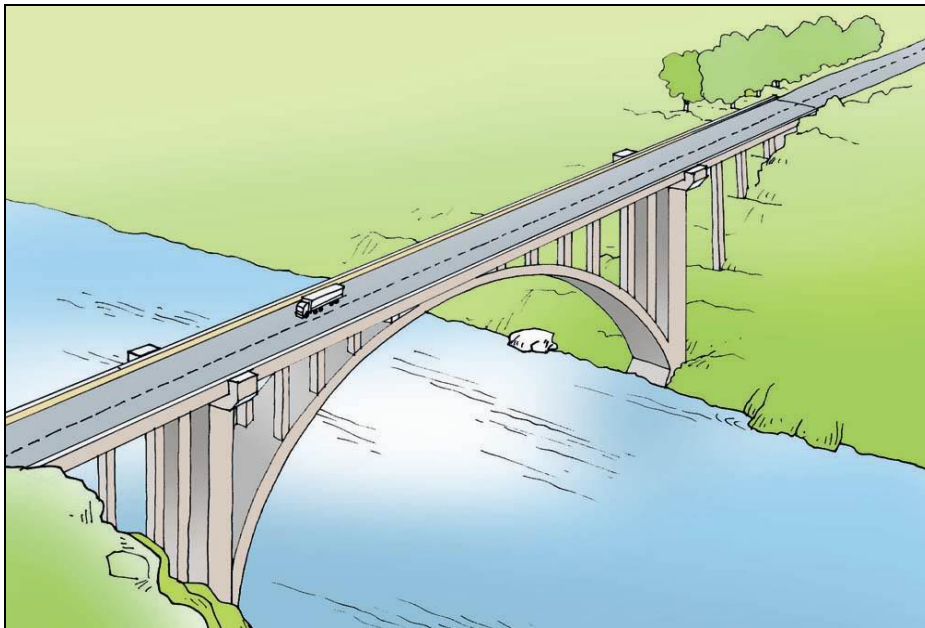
Puente Rio Negro carretera Bogotá – Villavicencio
